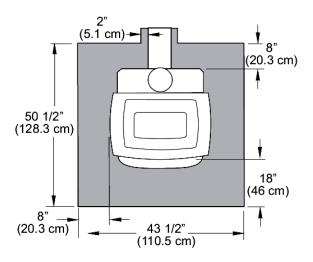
a. Dimensions minimales du protecteur de plancher, au Canada.
